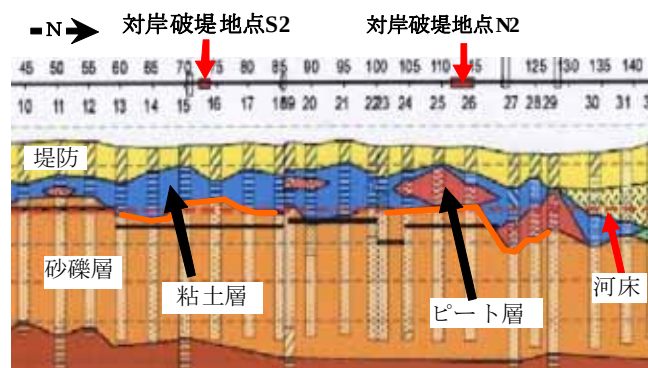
London Av. Canal の西側堤防土質縦断面図¹⁾
